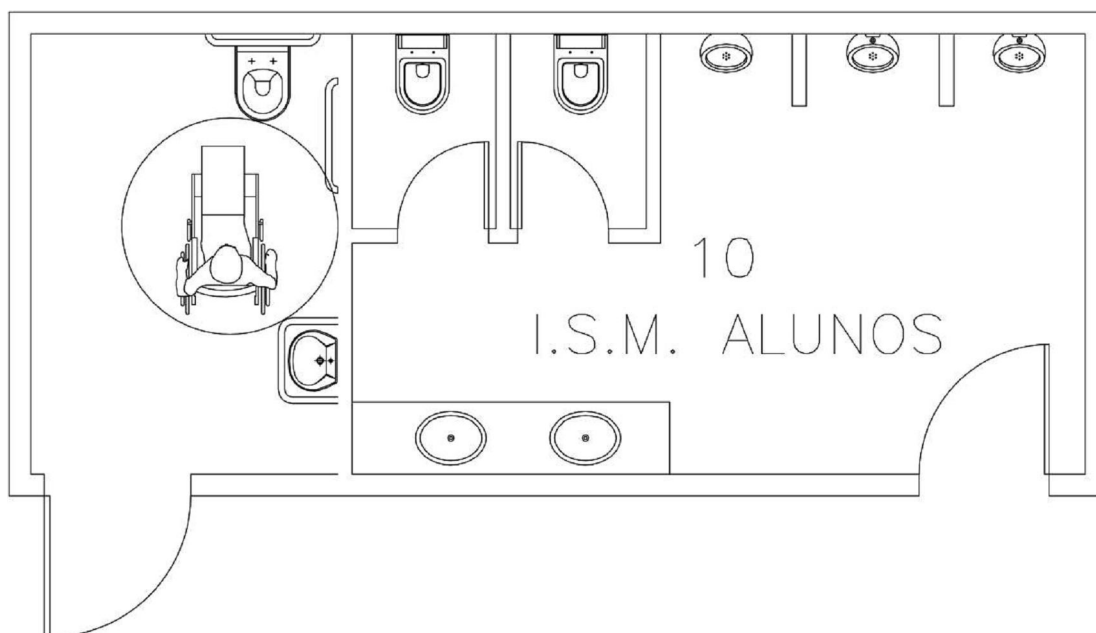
Planta Baixa sugerida Sanitário Masculino.
